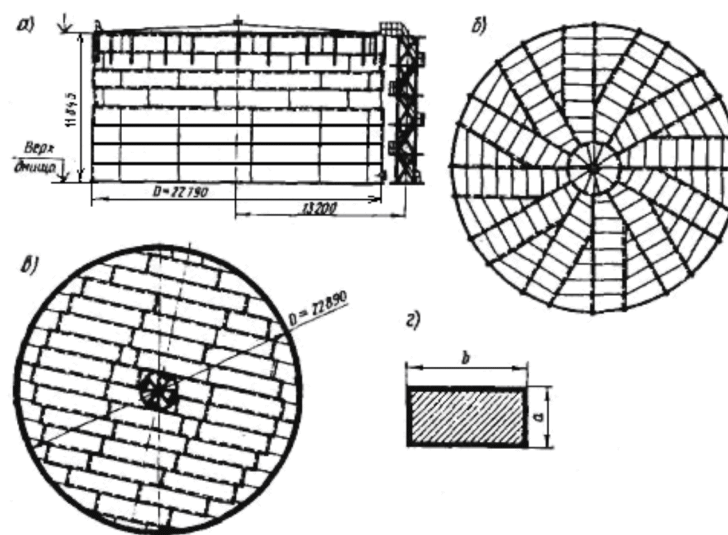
Общий вид резервуара объемом 5000 м³
